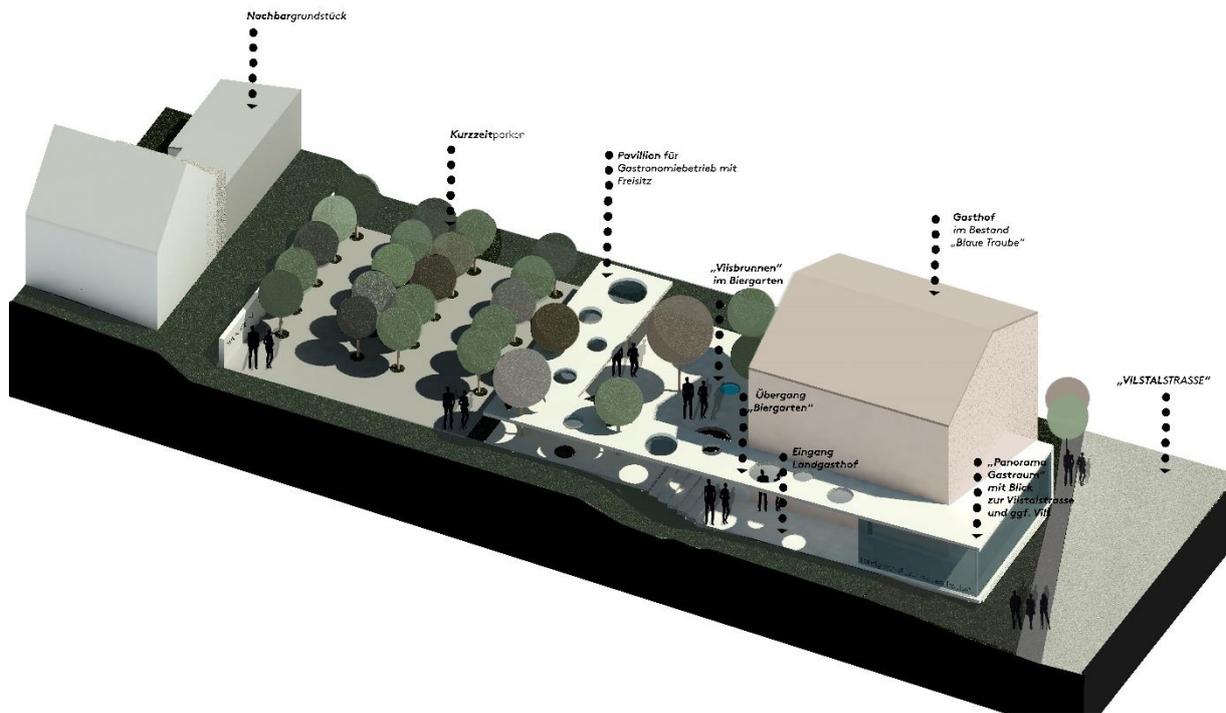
Vertiefungsbereich Station 01: Genuss und Verweilen, Schnitt und Lageplan (ROESCH Architekten und Stadtplaner GmbH)
